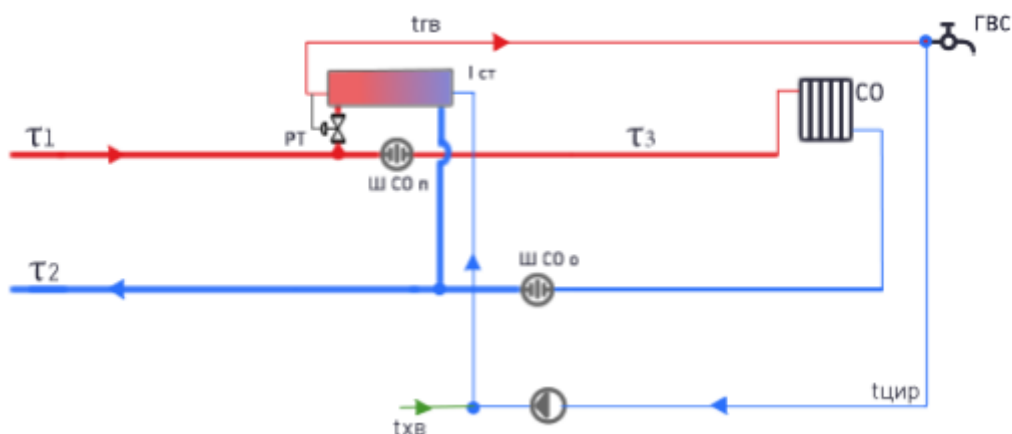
Схема подключения потребителей (нагрузка отопления и ГВС) по 2-х трубной схеме к тепловым сетям котельных Рузского городского округа.
